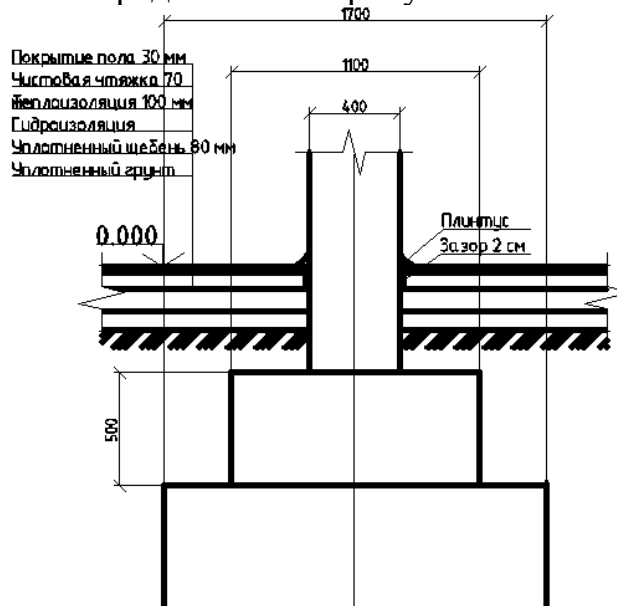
Общий вид фундаментов, конструкция пола
